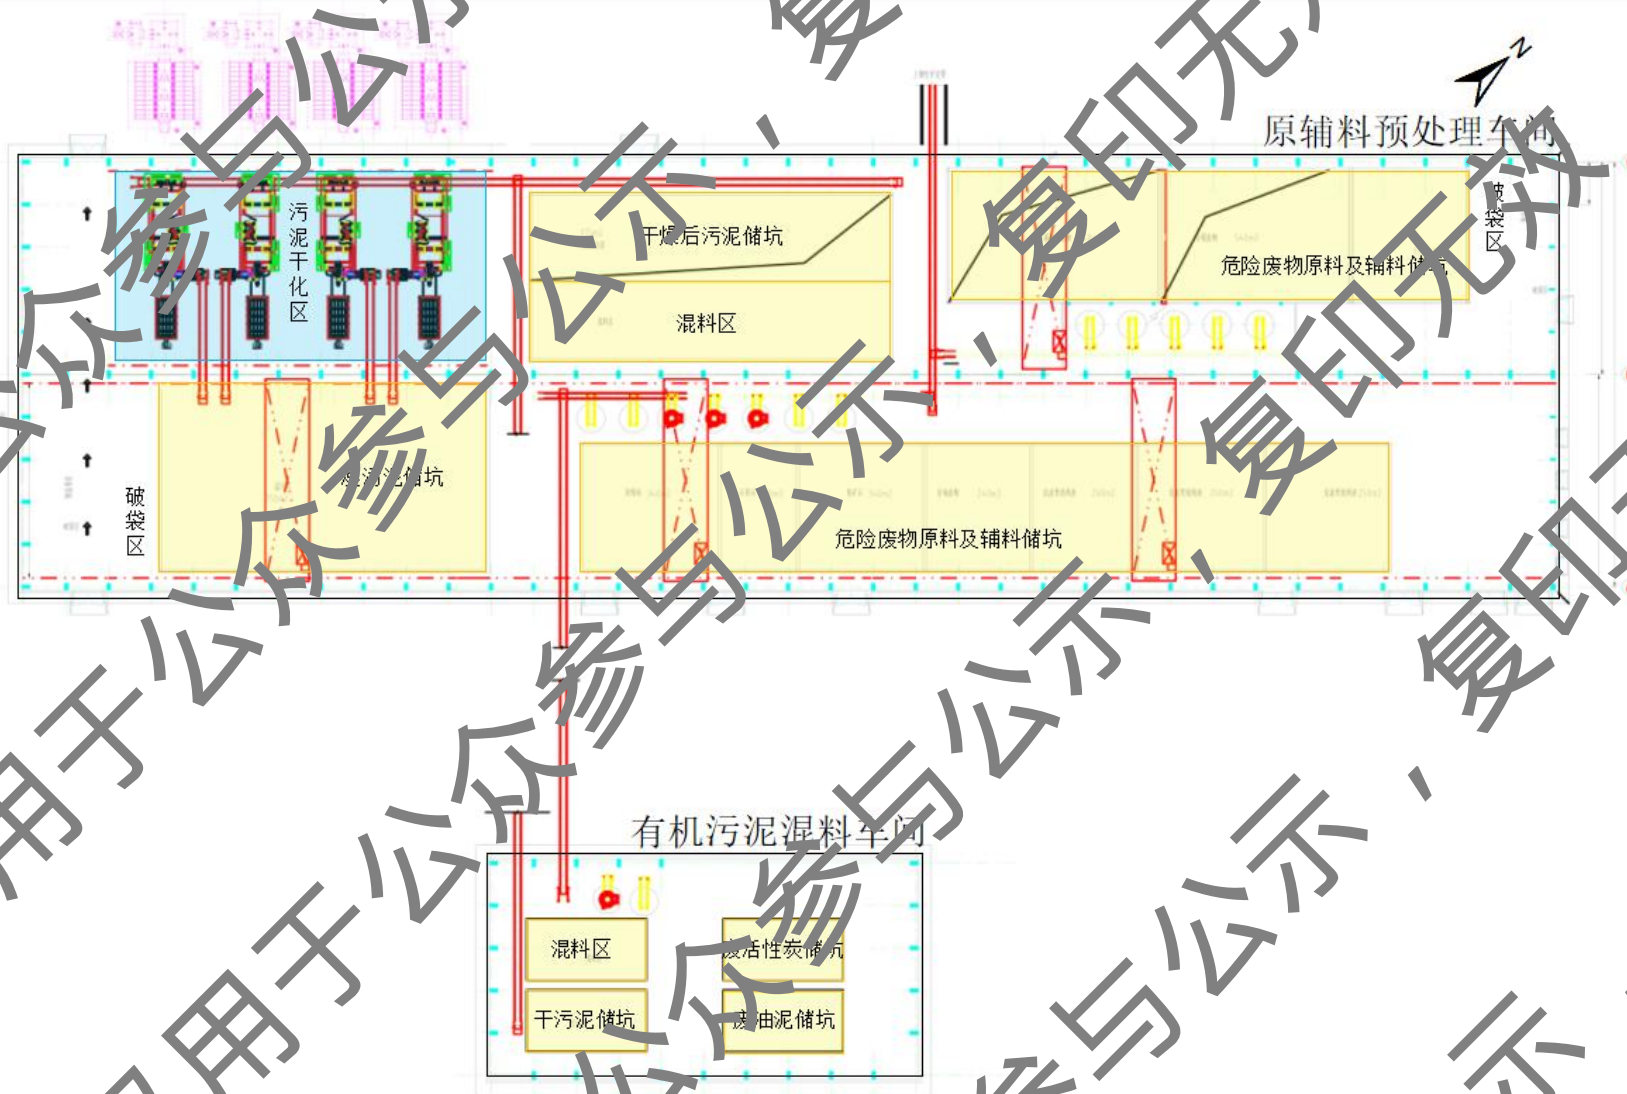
原辅料预处理车间级有机污泥混料车间平面布置图
